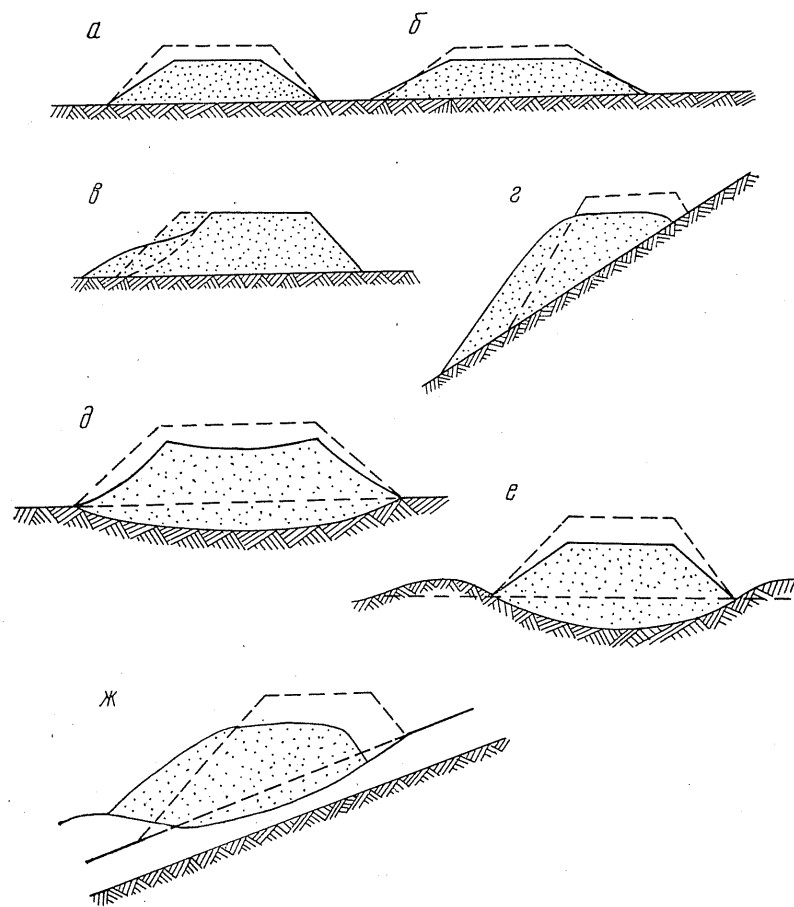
Виды деформаций насыпей: а — осадки от уплотнения грунта в теле насыпи; б — расползание насыпи; в — оползание откосов; г — сползание насыпи по поверхности косогора; д — осадка насыпи из-за уплотнения грунта основания; е — осадка из-за выжимания слабого грунта основания из-под насыпи; ж — сползание насыпи вместе с частью грунта косогора
